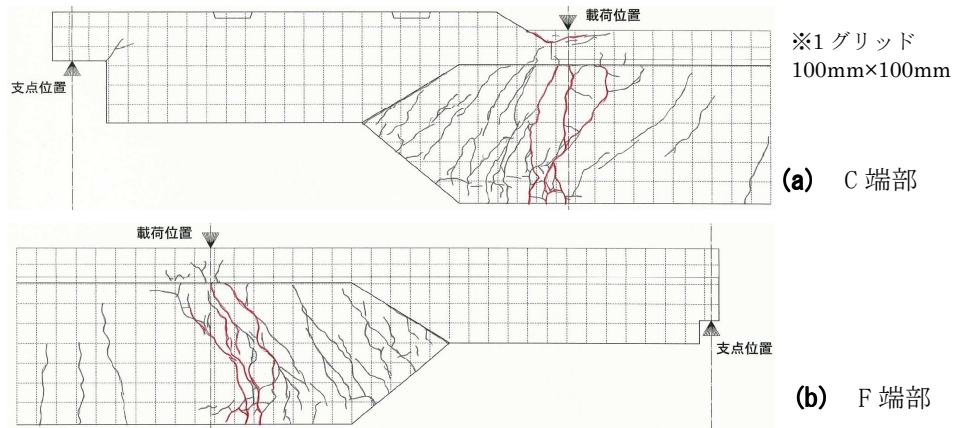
最終ひび割れ状況図 (赤線が最終破壊面)
